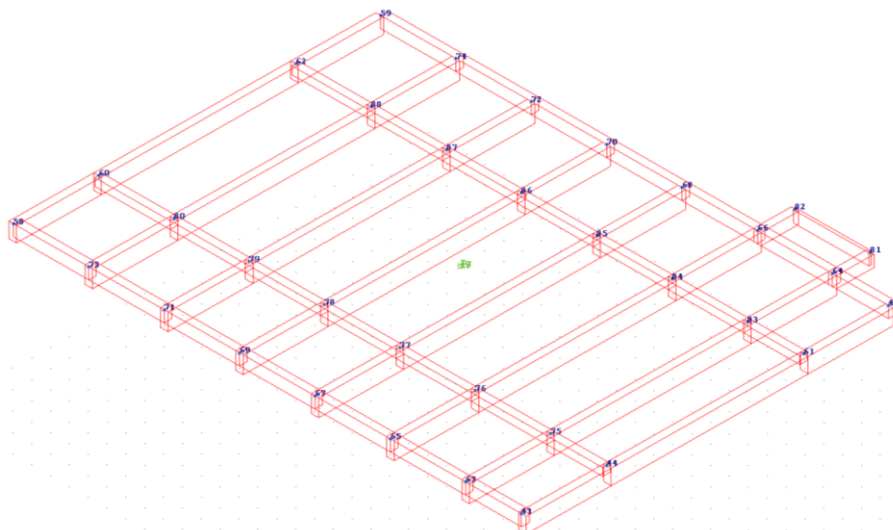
Qendra e masës dhe ajo e ngurtësisë për strukturën e palestrës
